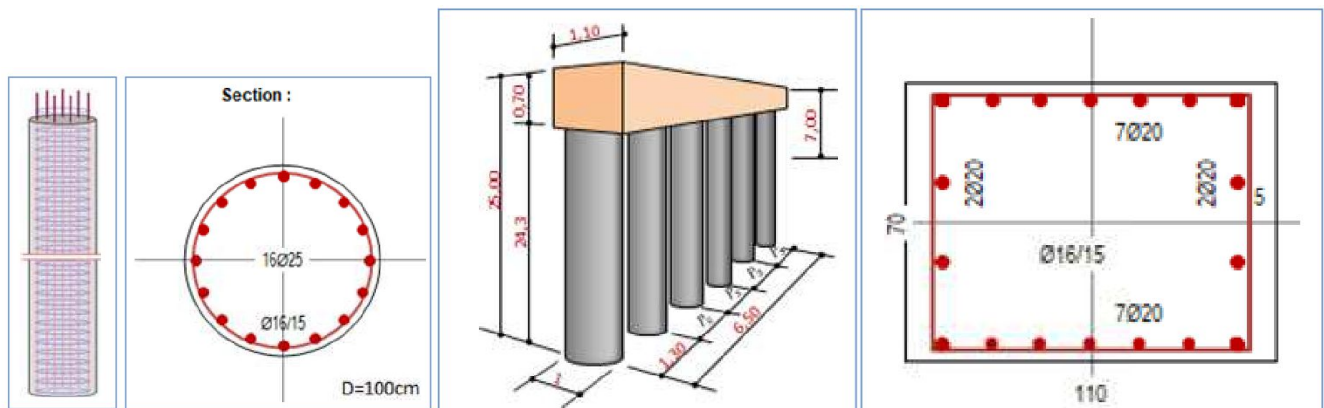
dimensions et ferrailage : pieux (à gauche) ; longrine en tête des pieux (à droite)
